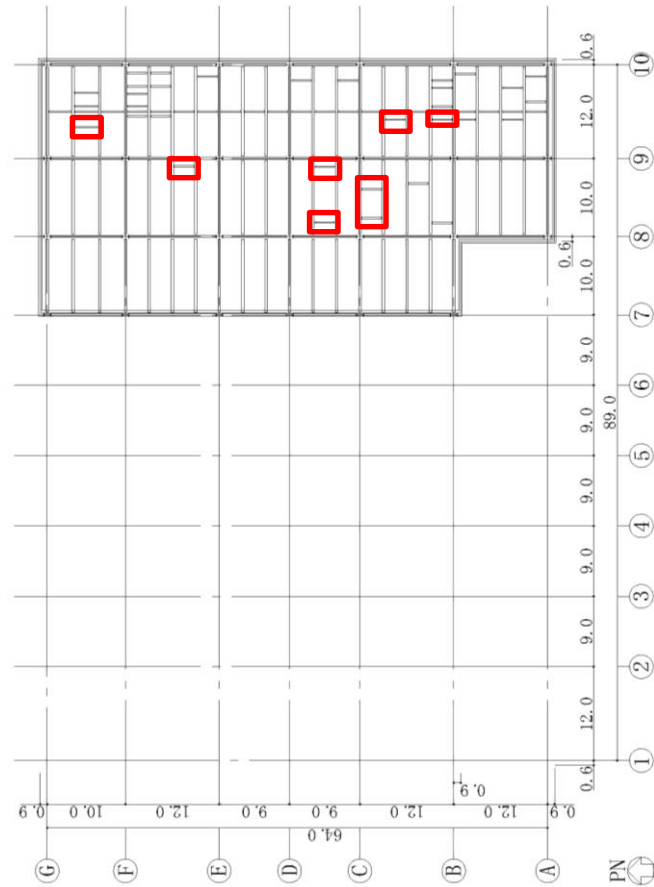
屋上階平面図 (G.L.+8.3) (単位 : m)
